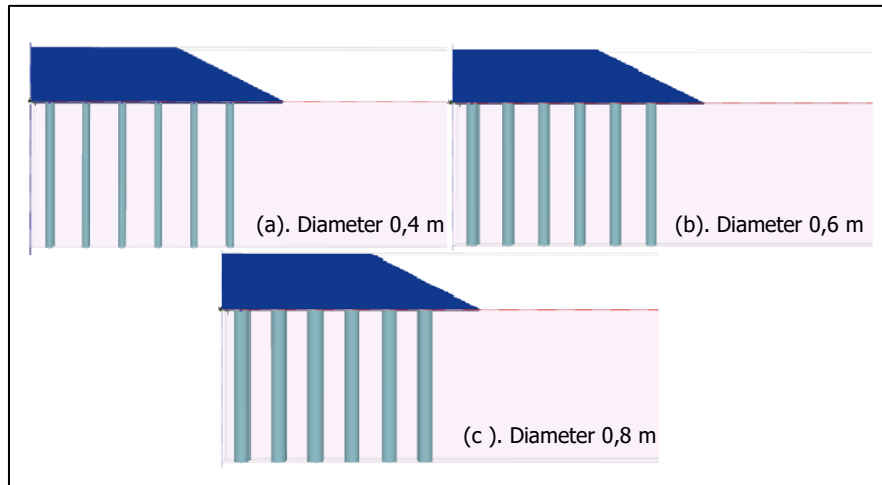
Pemodelan *deep mixed column* dengan jarak 1,4 m
